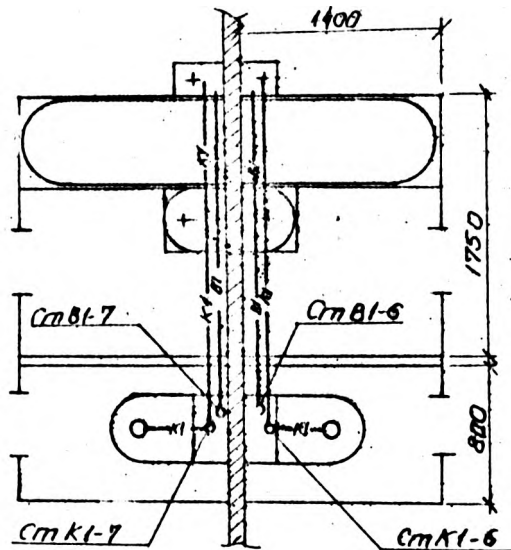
Трассировка водопровода и канализации на плане санитарных узлов:
